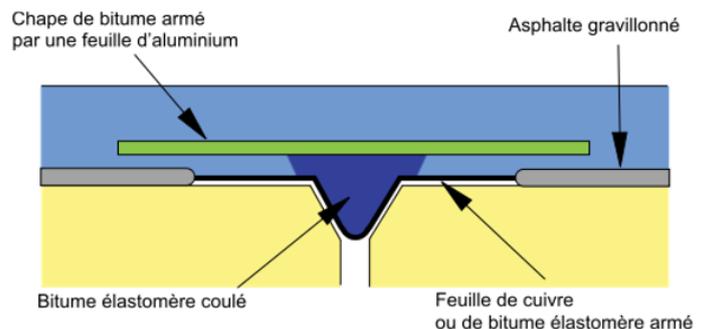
Joint non apparent à revêtement normal (ABN Building Corporation.com)
